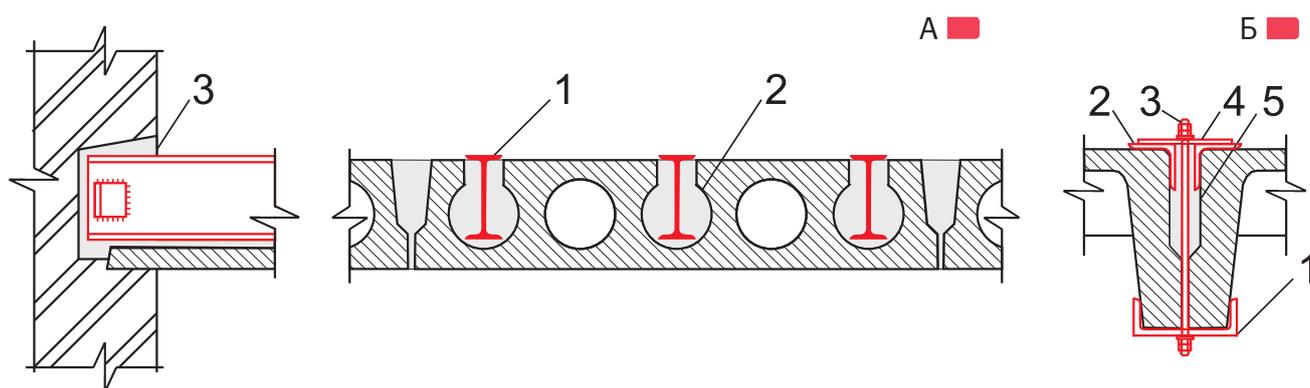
Увеличение сечения железобетонных плит. Для многопустотных: А – установкой в раскрытые пустоты стальных балок и последующим бетонированием: 1 – двутавр, вводимый в полость; 2 – заполнение раствором со щебневым отсеком; 3 – приваренный уголок для анкерования в опорной зоне. Для ребристых: Б – стальными швеллерами и полосами с совместной работой: 1 – швеллер; 2 – уголки; 3 – стяжная шпилька; 4 – пластина; 5 – заполнение раствором
